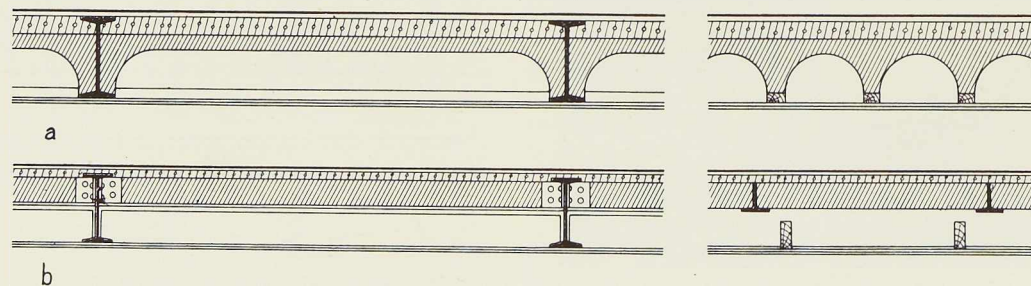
Type de planchers en béton armé, en forme de voûte et en dalles coulées à l'avance.
